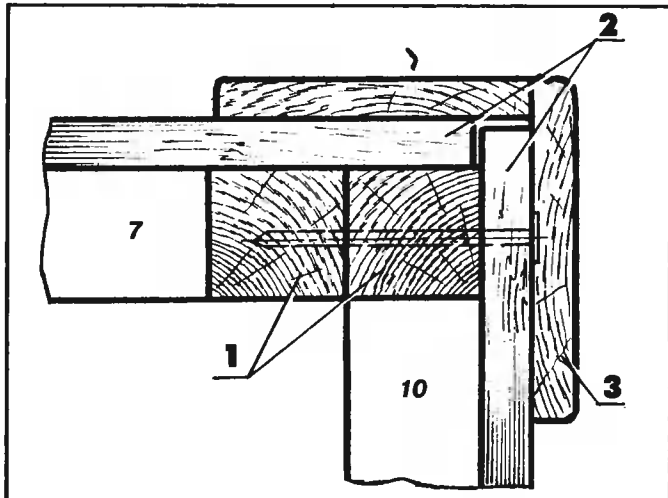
Конструкция угла: 1 – стойки угловых панелей; 2 – наружная обшивка (вагонка); 3 – короб из досок
